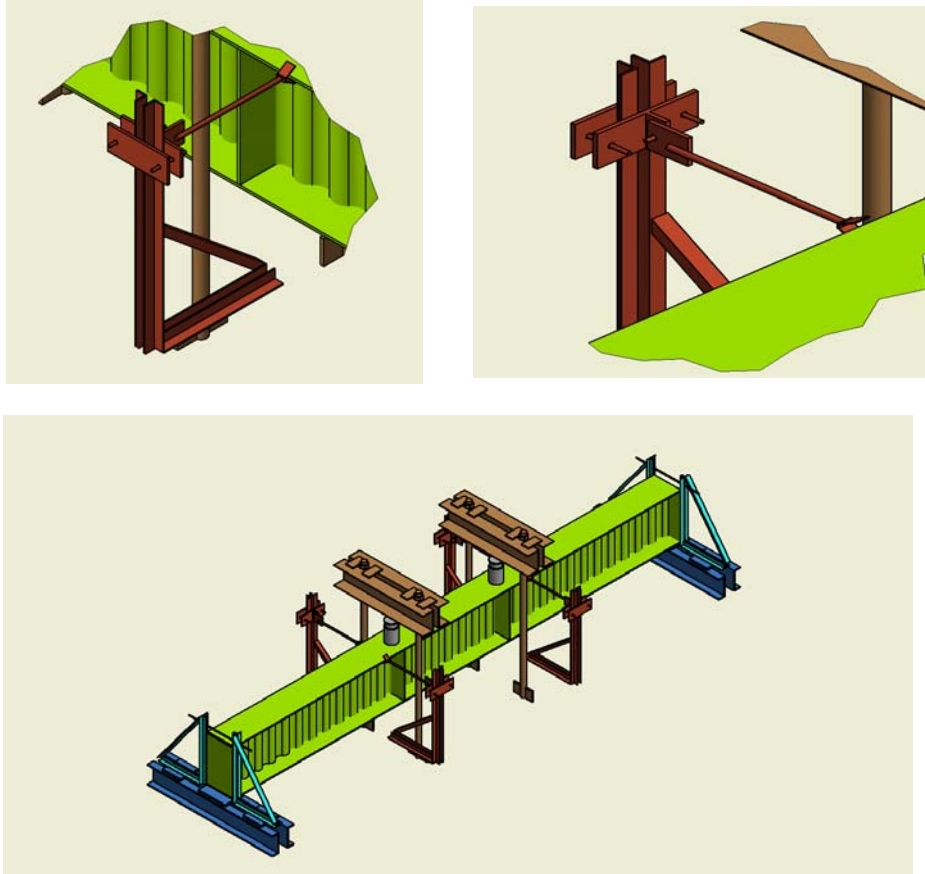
Розкріплення верхнього стиснутого поясу балки
